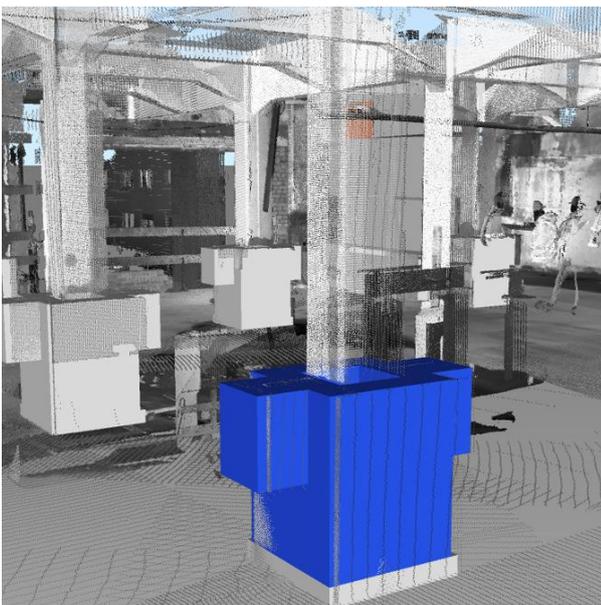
Überlagerung des Plan-Modells mit der Punktwolke³⁴⁰
